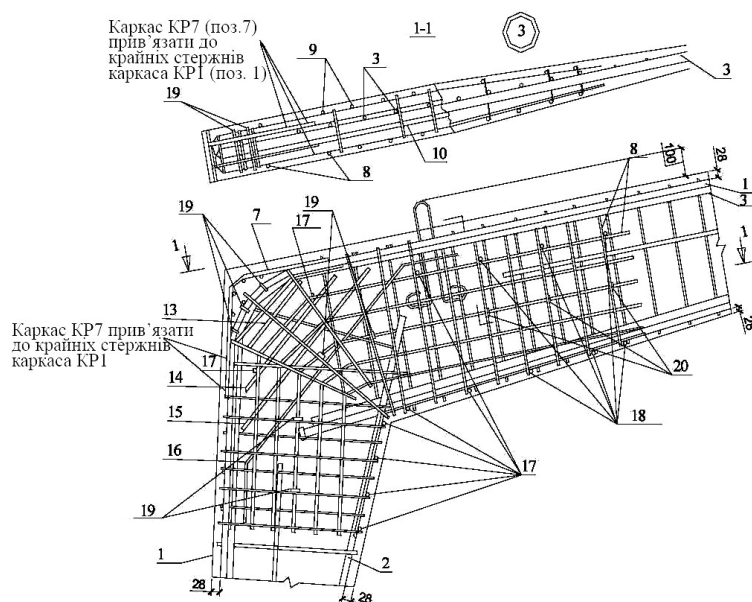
Армирование узла соединения ригеля со стойкой сплошных полурам РЖУ (Укрколхозпроект, КНУБА)
